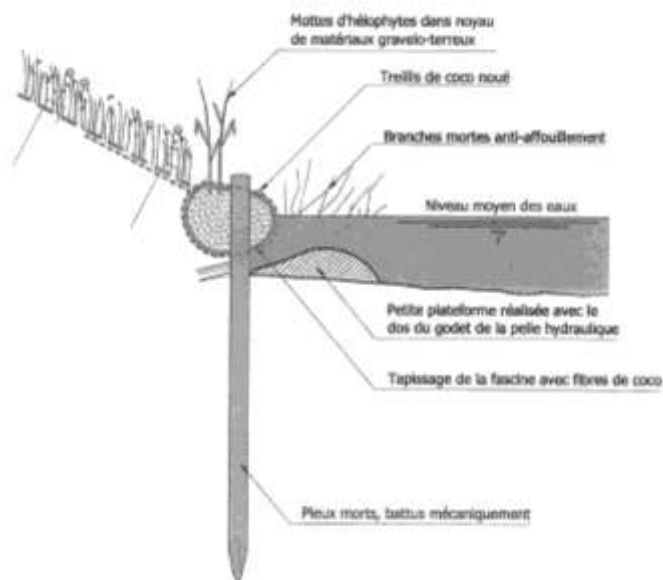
Profil en travers d'une fascine de plantes d'hélophytes (SILENE BIOTEC)
